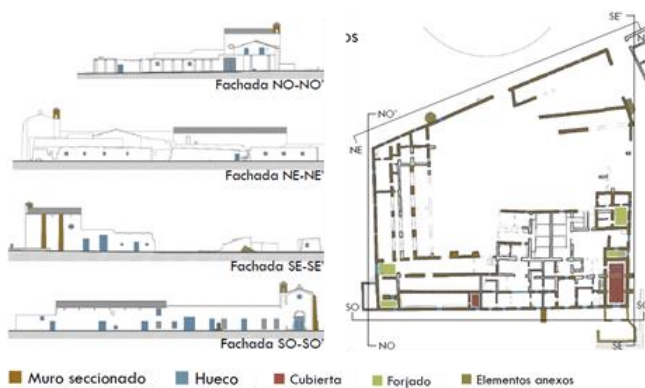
Elementos constructivos analizados. Planta y cuatro alzados del Cortijo del Fraile. Elaboración propia a partir de Egmasa (2010).
